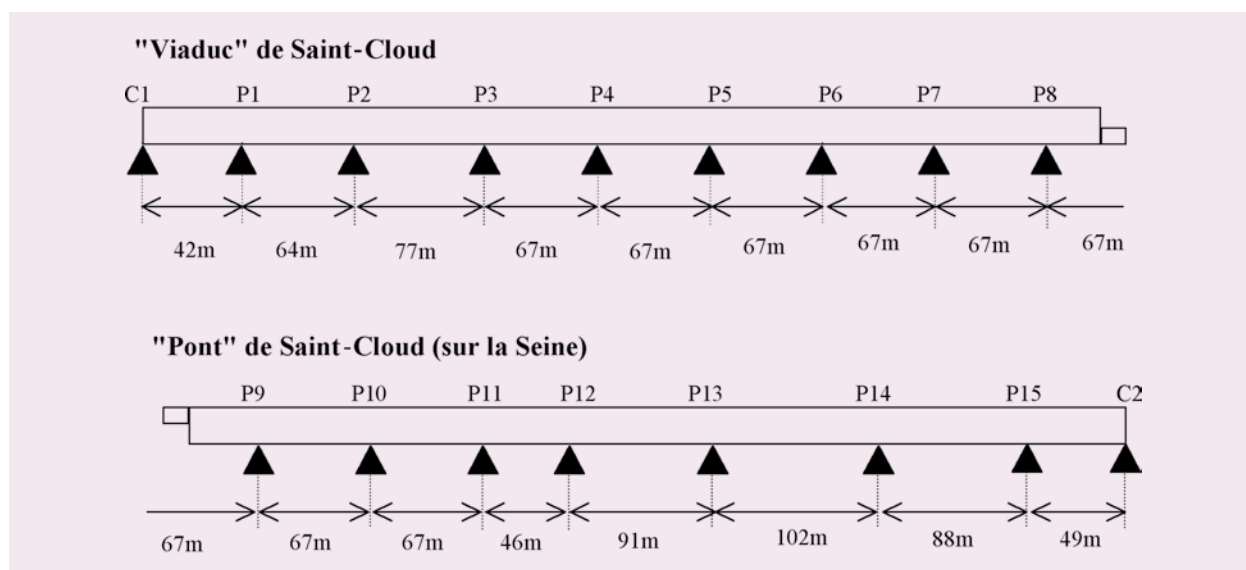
coupe longitudinale des deux ouvrages reliés par un appui cantilever
